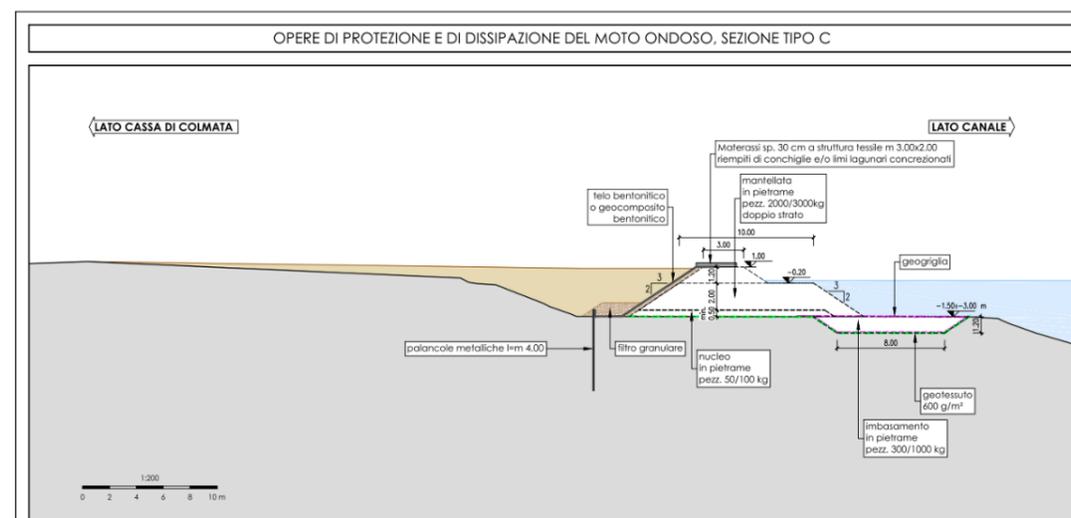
opere di protezione e dissipazione sezione tipo C
